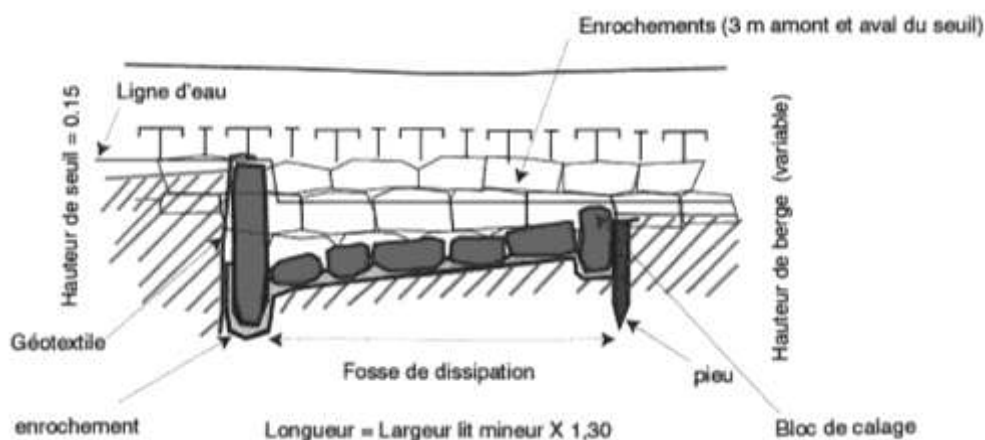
Profil en long d'une rampe de fond (EAUX CONTINENTALES)
